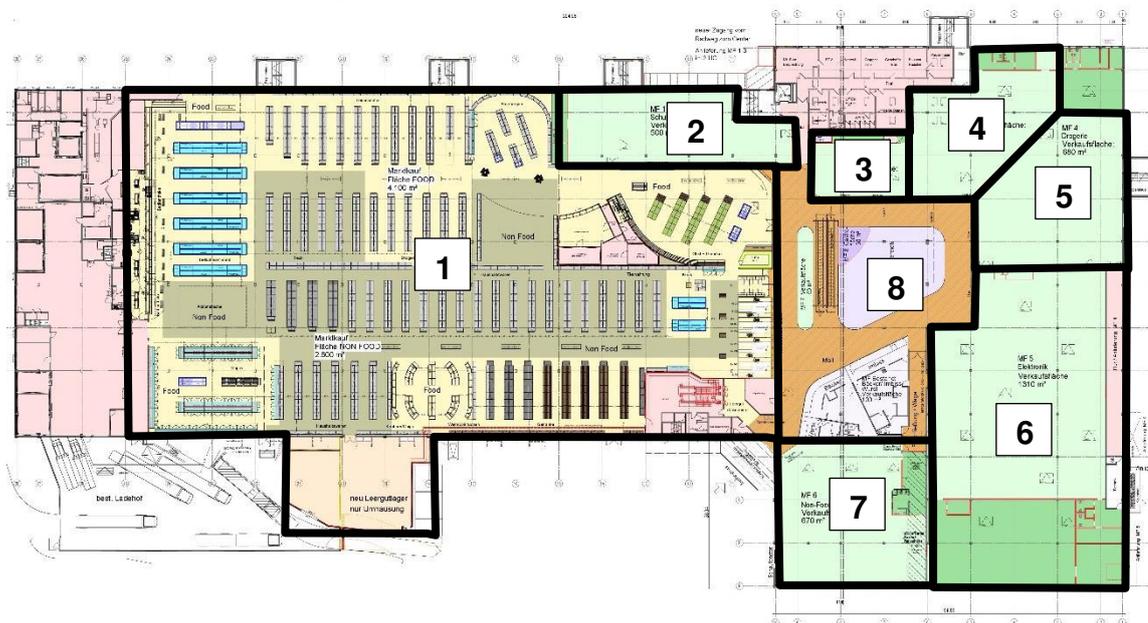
Auszug Grundriss EG-Gesamtkonzept nach Umbau, Quelle: Architekturbüro Wittig, 2021
